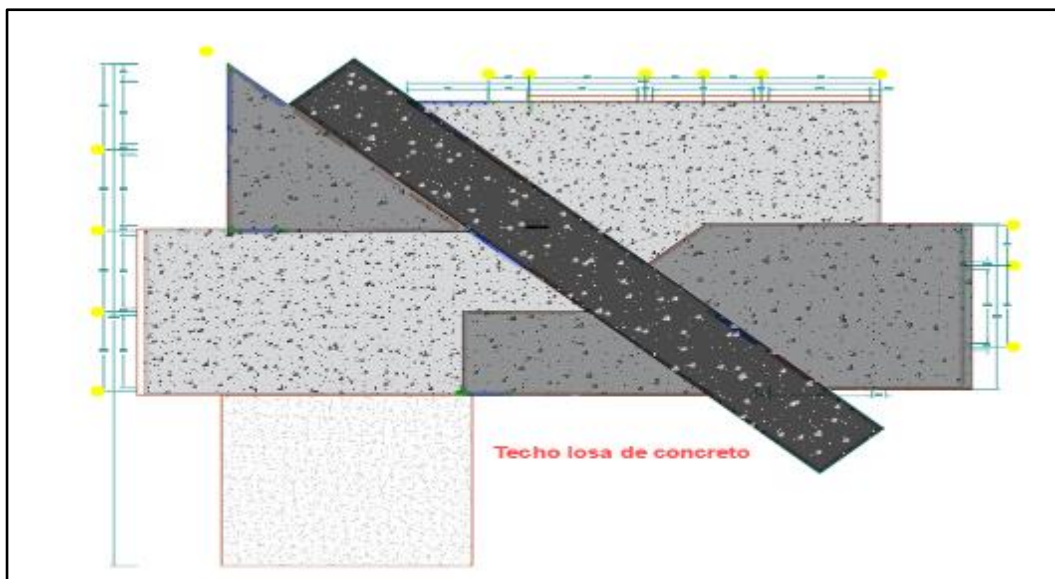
Vista en planta del techo del pabellón H - FIUPLA
